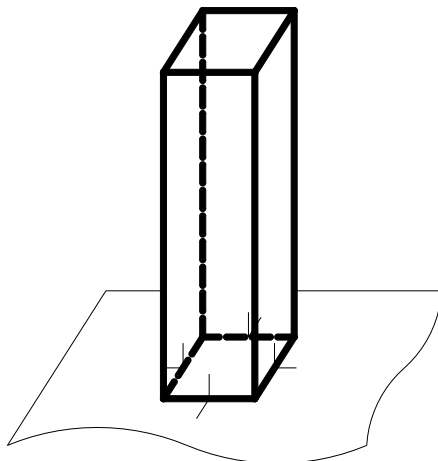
Схема разбивки осей при монтаже колонн
